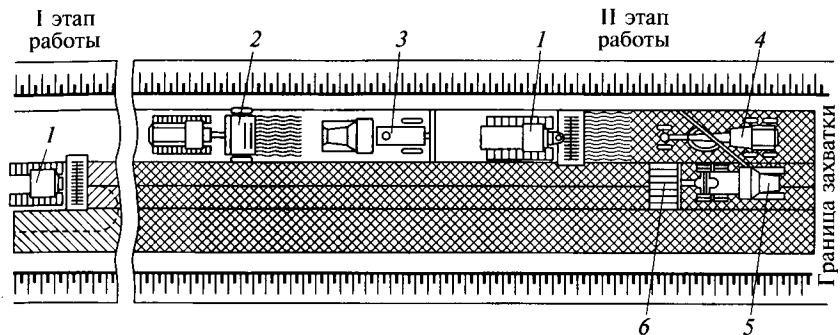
Технологическая схема строительства дорожной одежды из местного грунта, укрепленного цементом:
